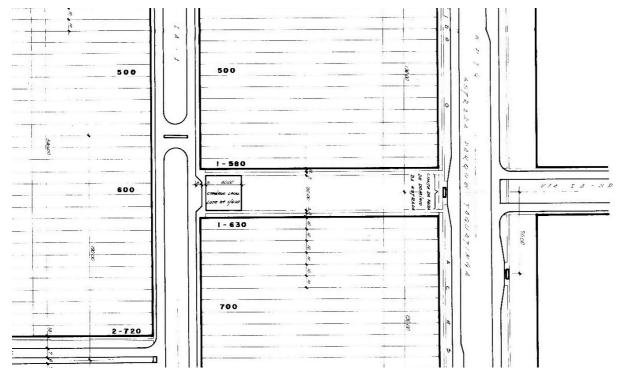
Recorte da planta registrada SIA - PR 2/1. Fonte: Mapoteca
